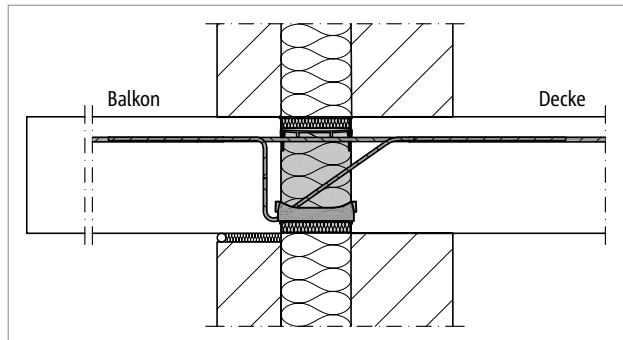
Schöck Isokorb® XT Typ K: Anschluss bei zweischaligem Mauerwerk mit Kerndämmung
